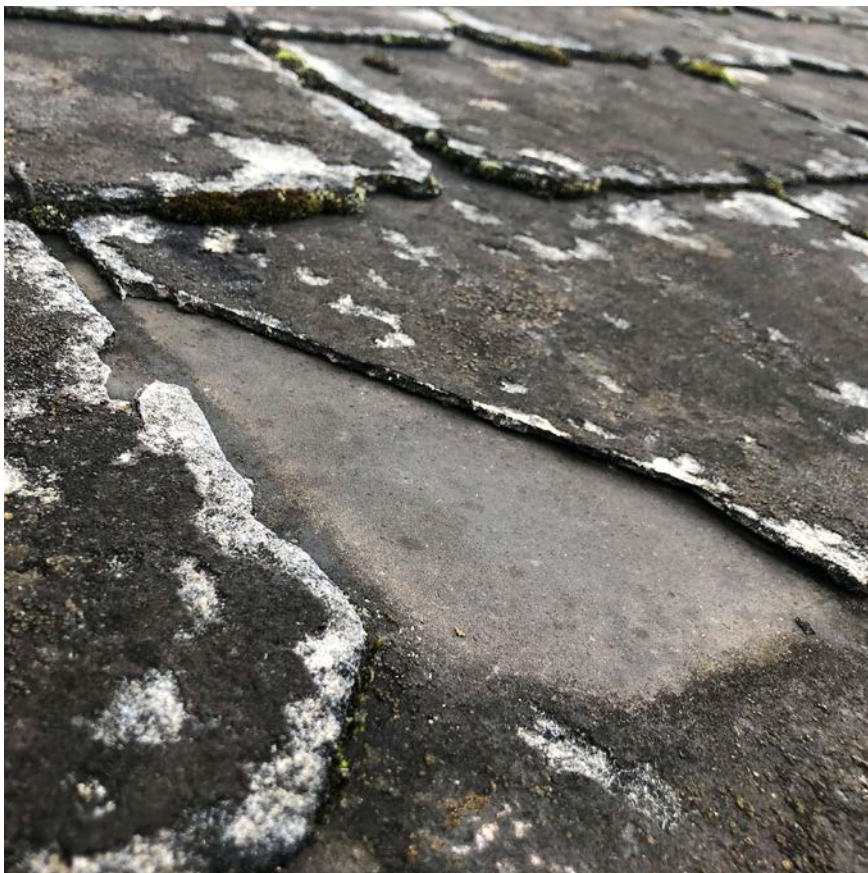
Sur un toit en pente, coin brisé d'un bardeau en fibres-ciment. L'état des autres bardeaux suggère que le bardeau endommagé était déjà fragilisé en raison de son âge. (source : ECAP)
